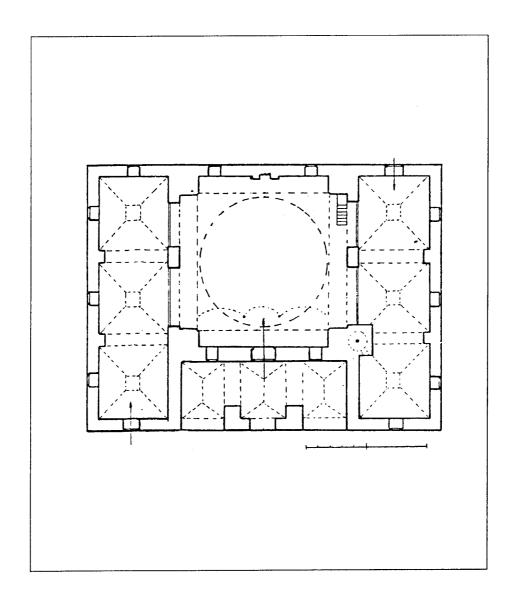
مسقط أفقي لمسجد السوق في Gjirokastër (عن : كيل) .
